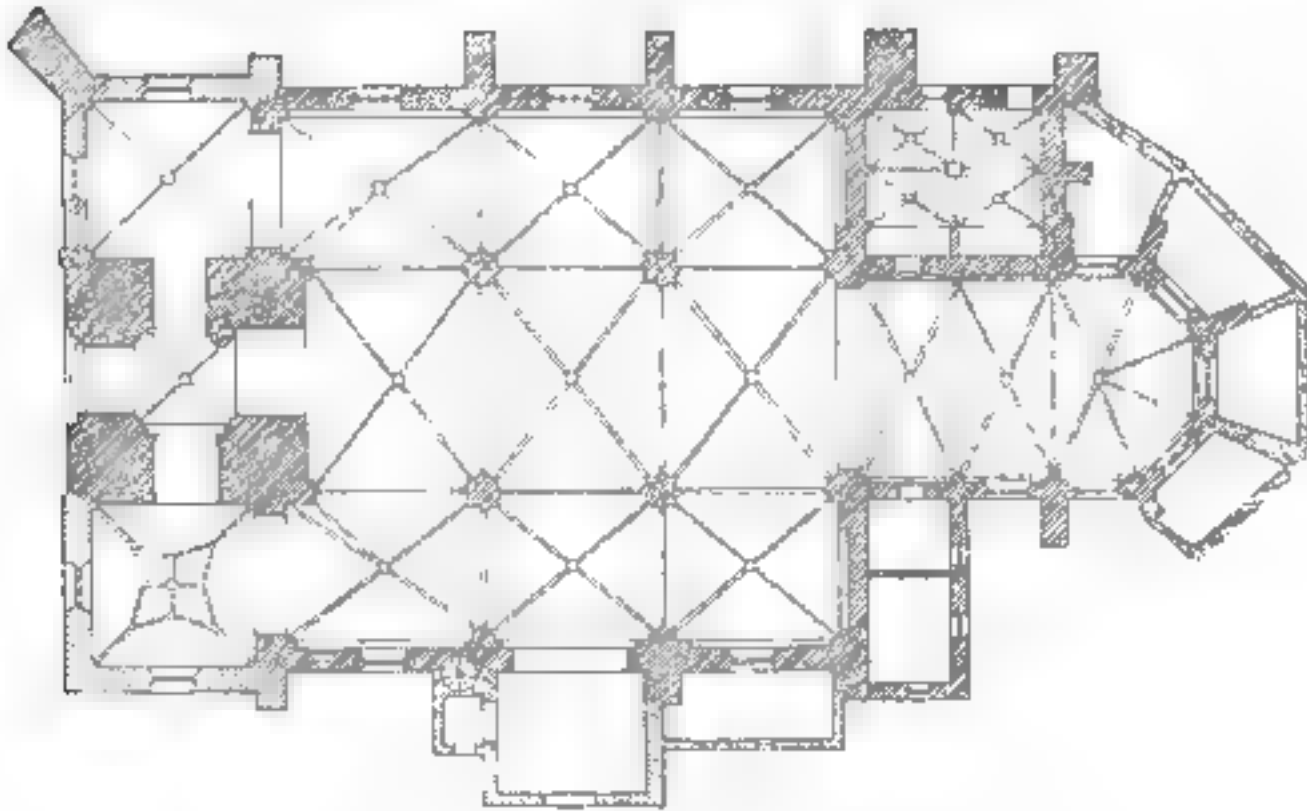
Grundriss der St. Nicolai-Kirche vor der Erneuerung
